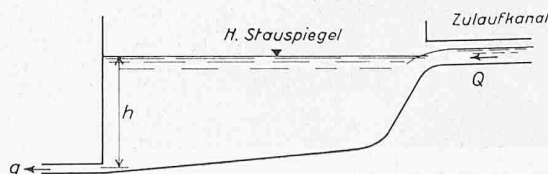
Rückhaltebecken Typ A mit selbsttätiger Entleerung
